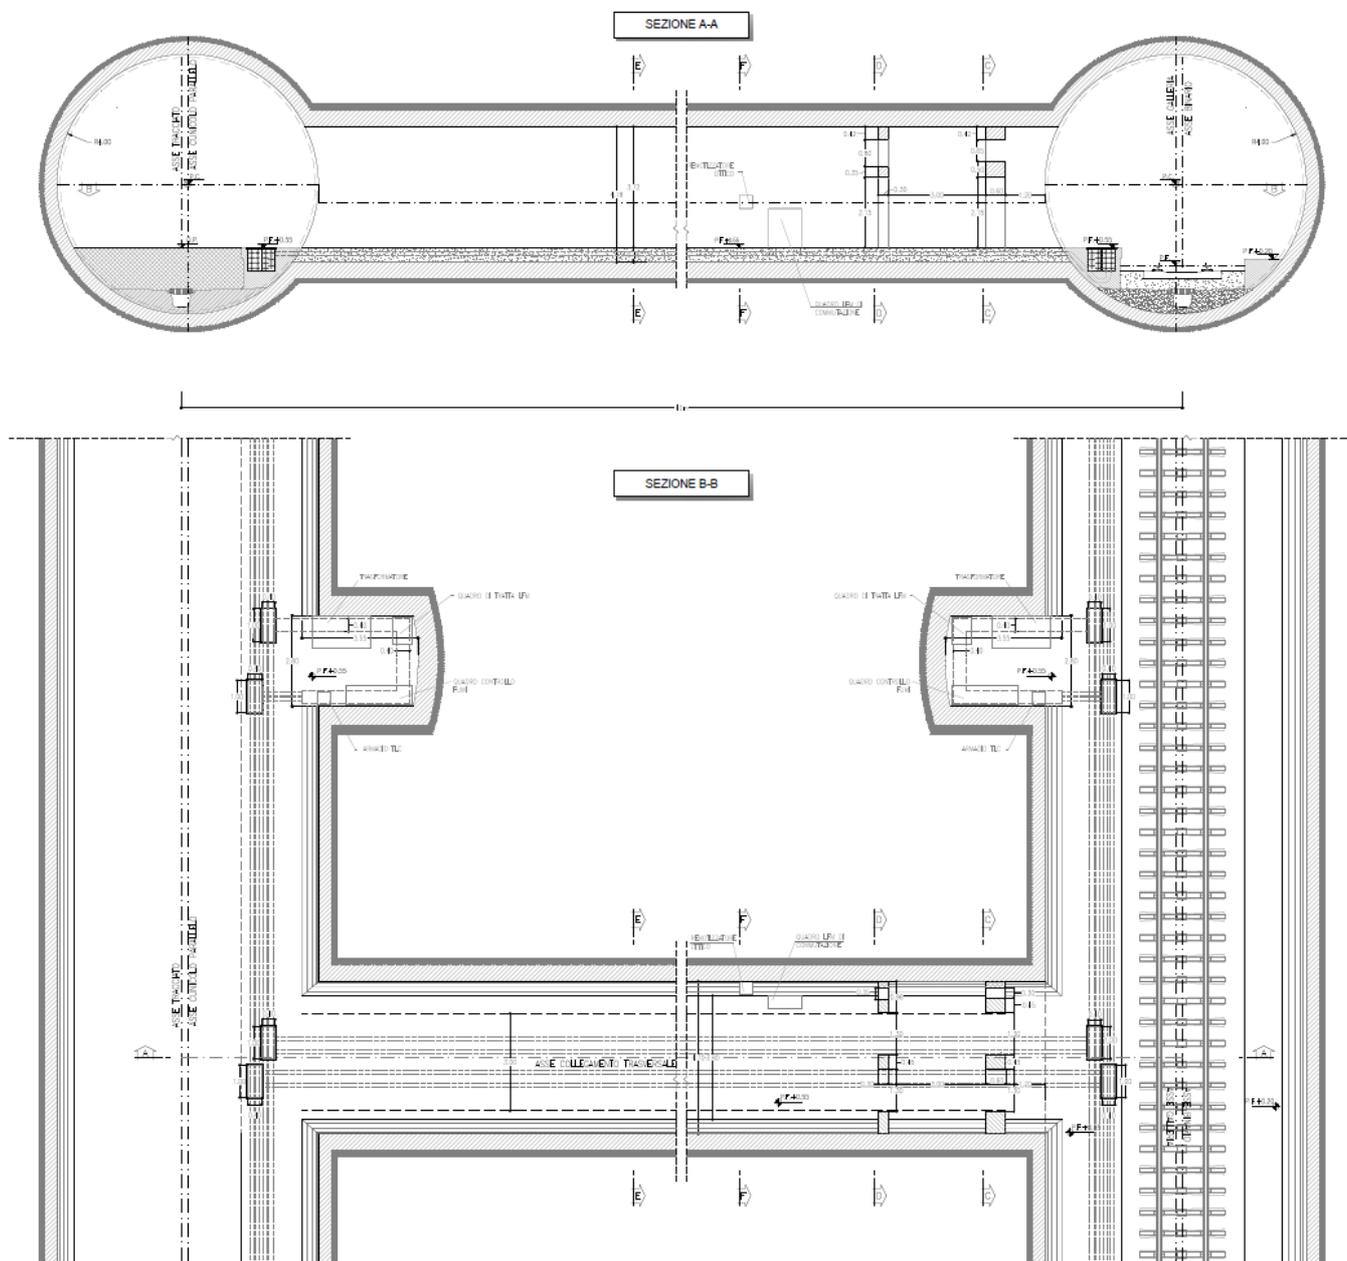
Collegamenti trasversali tra canna ferroviarie e cunicolo – pianta e profilo (scavo meccanizzato)
